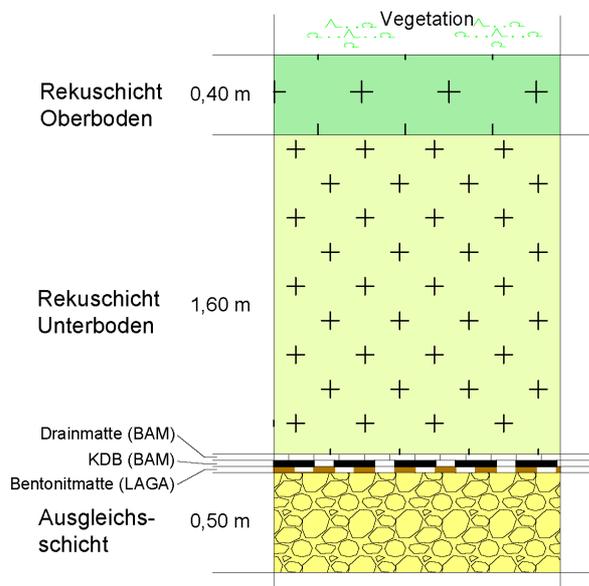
Detail Aufbau Oberflächenabdichtungssystem
